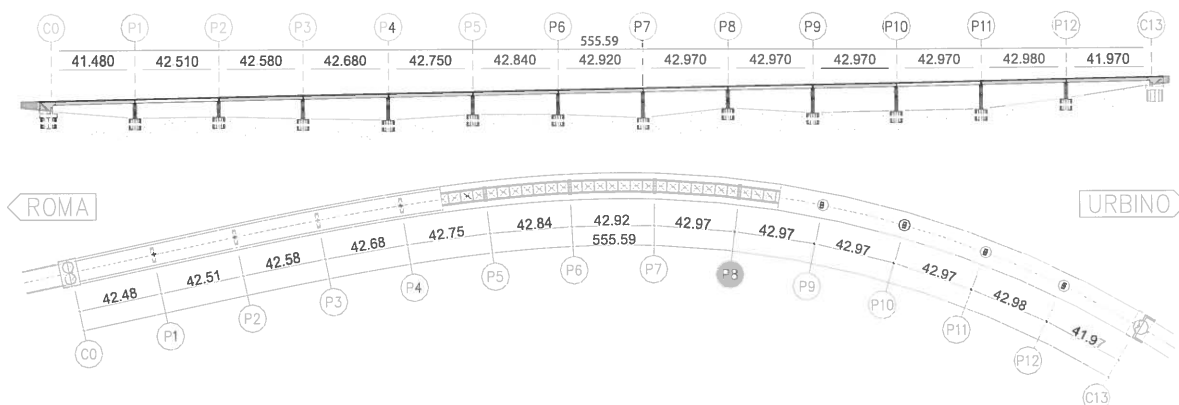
Viaduc Ca' Raniero 1 : Élévation et vue en plan / Elevation and plan view
